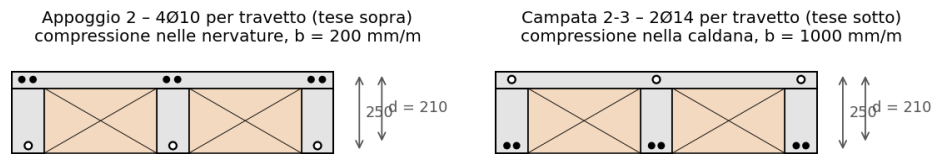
Sezioni tipo del solaio armato: appoggio 2 e campata 2-3.
